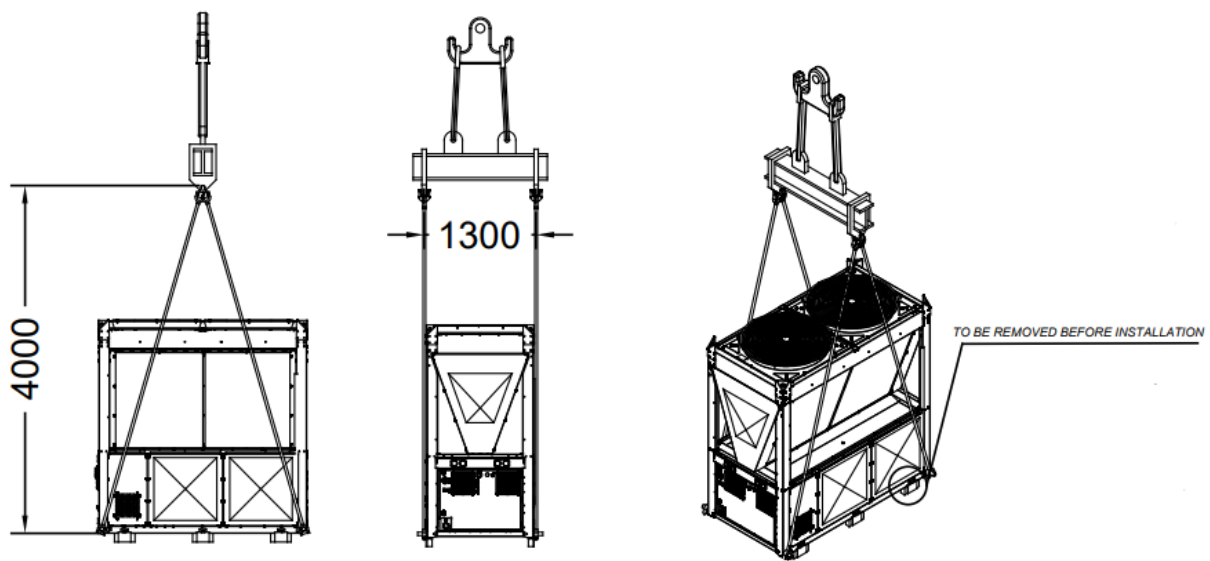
Instrucciones de elevación con puntos de elevación inferiores
